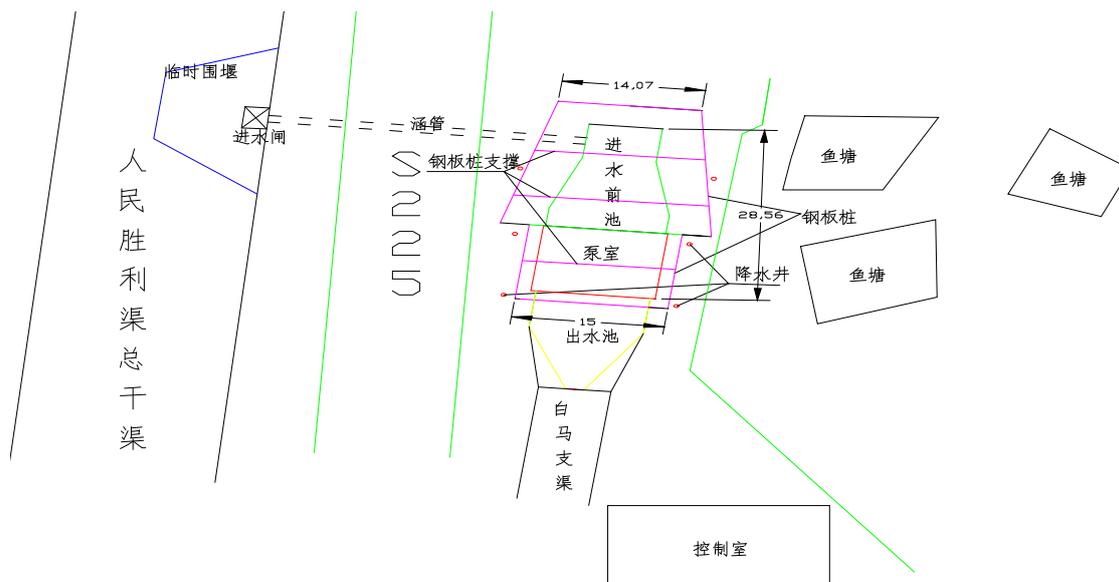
白马提灌站前池及泵室基础开挖支护降水平面布置图
